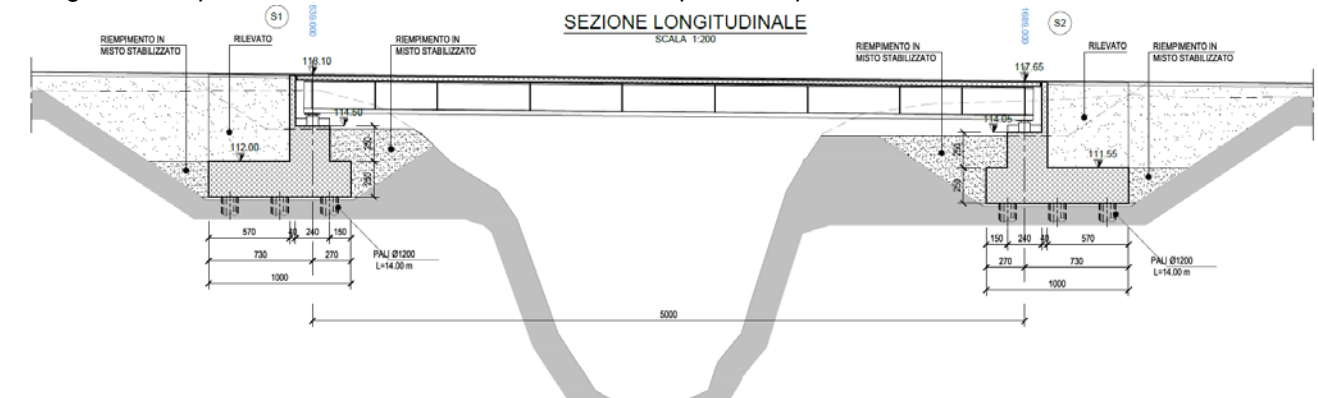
Ponte Torrente Gravina: Sezione longitudinale
